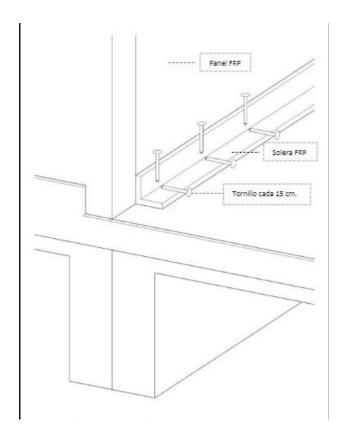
Vista en detalle de la unión de los paneles de muros a la solera.
